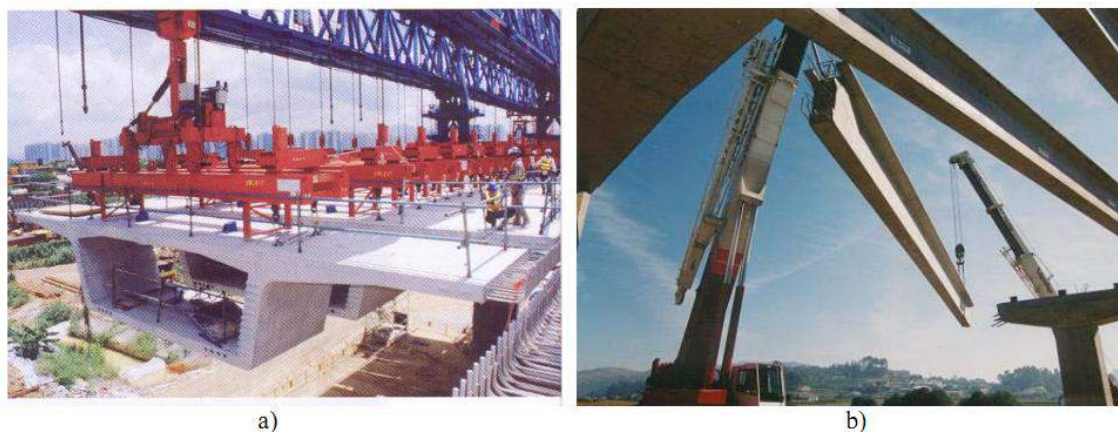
Elementos pré-moldados utilizados em tabuleiros de pontes: a) aduelas pré-moldadas; b) içamento de vigas pré-moldadas de concreto protendido. Fonte: SOUZA (2004).
